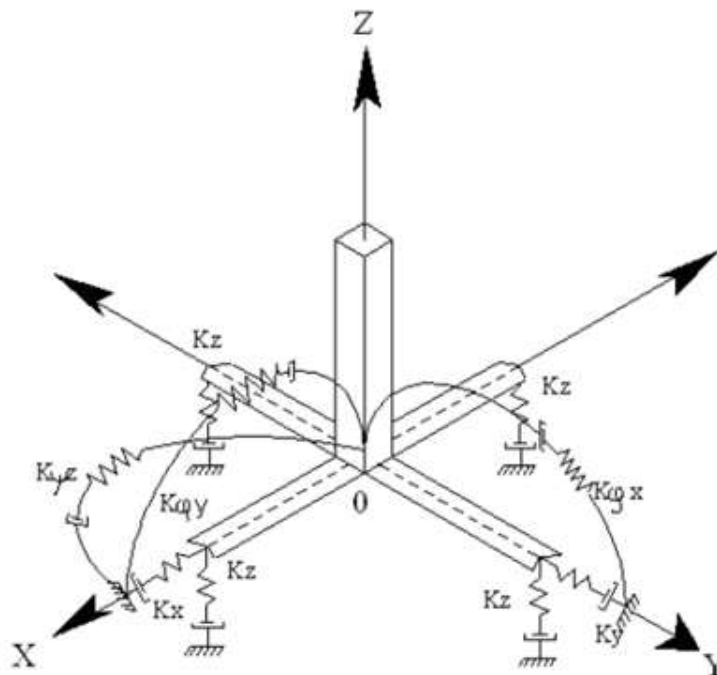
Esquema 3D de cálculo de la cimentación con Interacción Suelo-Estructura de zapata aislada, recuperado de Villareal, G. 2009: “INTERACCION SISMICA SUELOESTRUCTURA EN EDIFICACIONES CON ZAPATAS AISLADAS”
